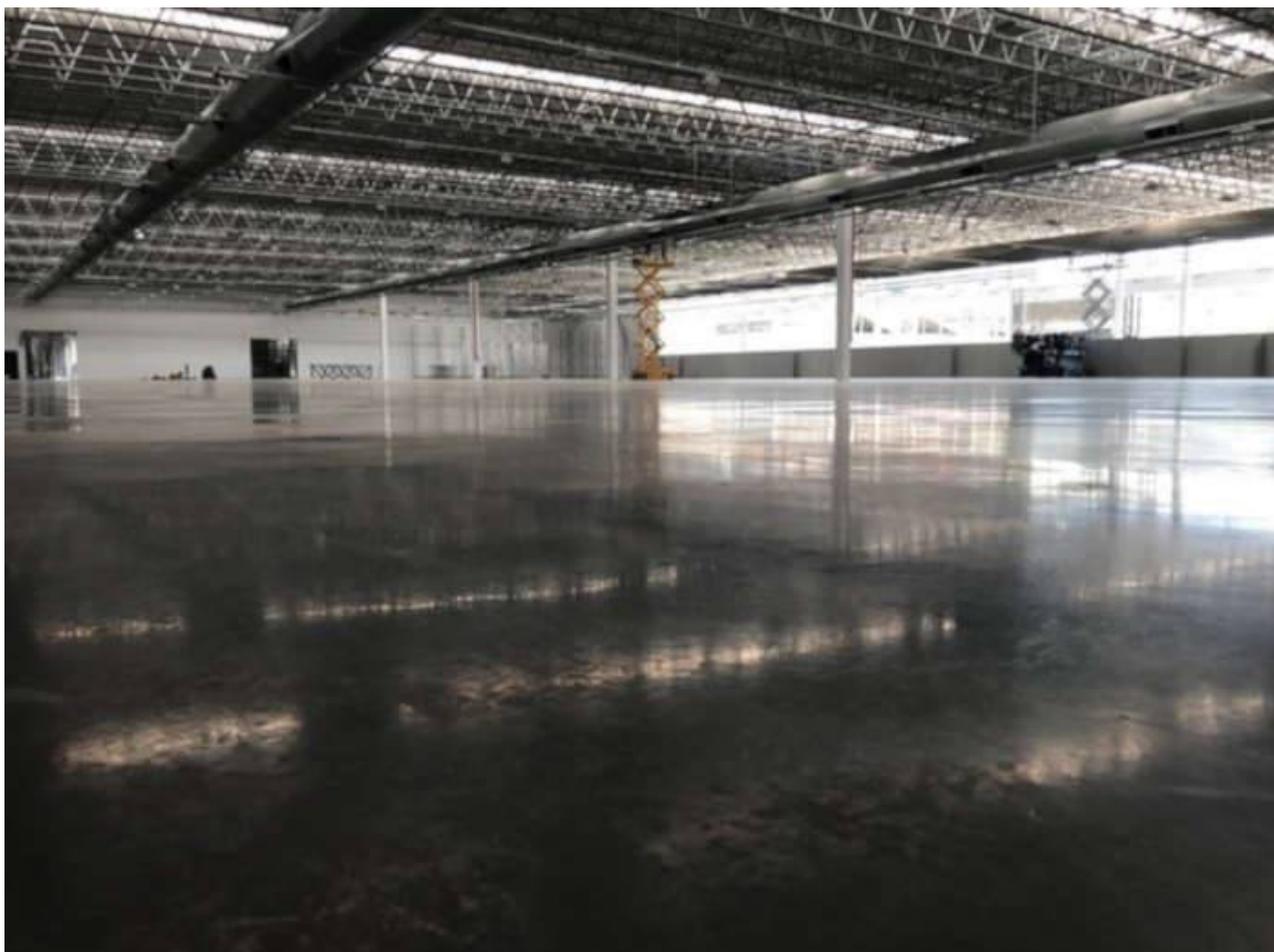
Foto di un pavimento industriale senza nessun giunto di dilatazione.
